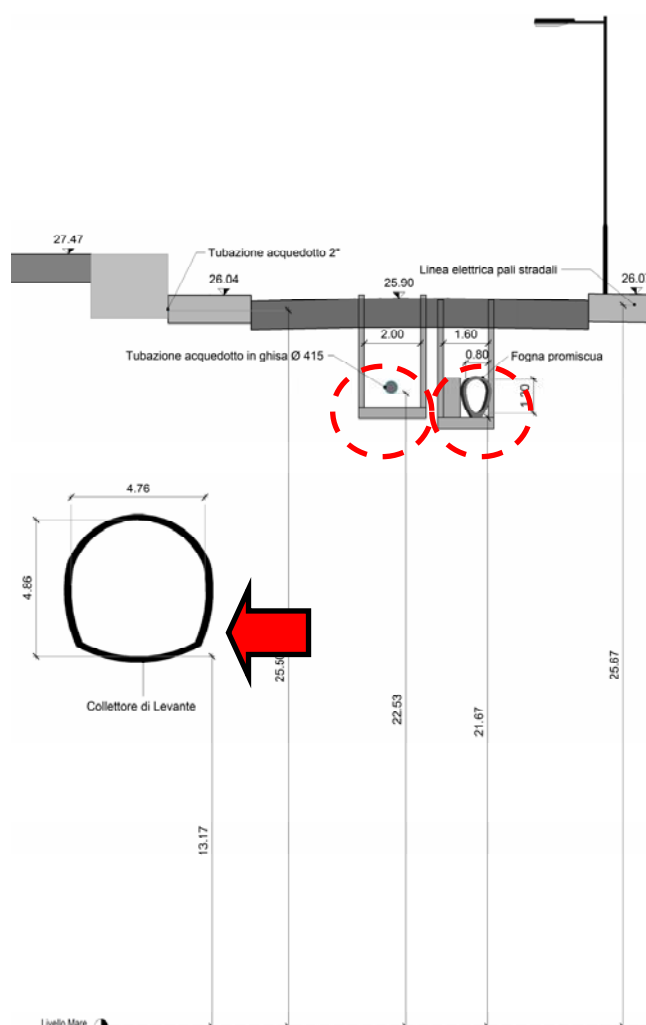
sezione di rilievo – cerchiare infrastrutture idrauliche e con freccia rossa indicato collettore di levante
